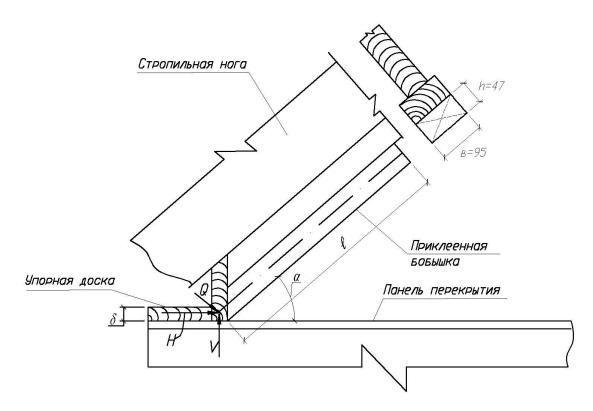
Опирание стропильных ног на панель перекрытия
